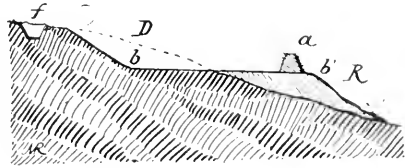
Coupe en travers d'une route en déblai-remblai.
